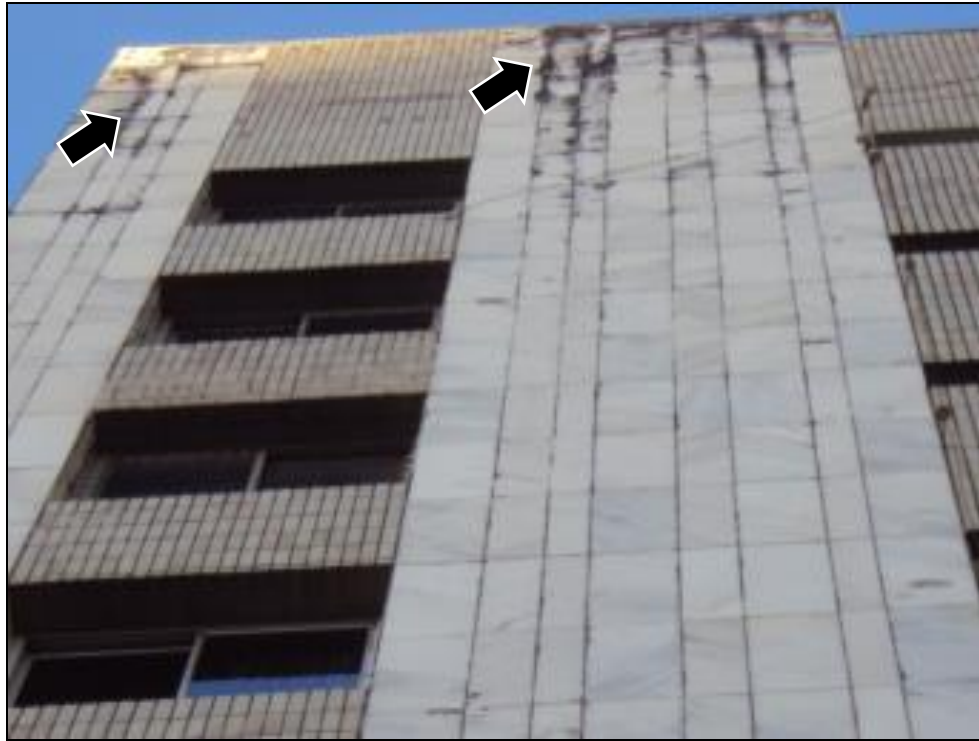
Fachada Sur (trechos T2, T3 e T4).
